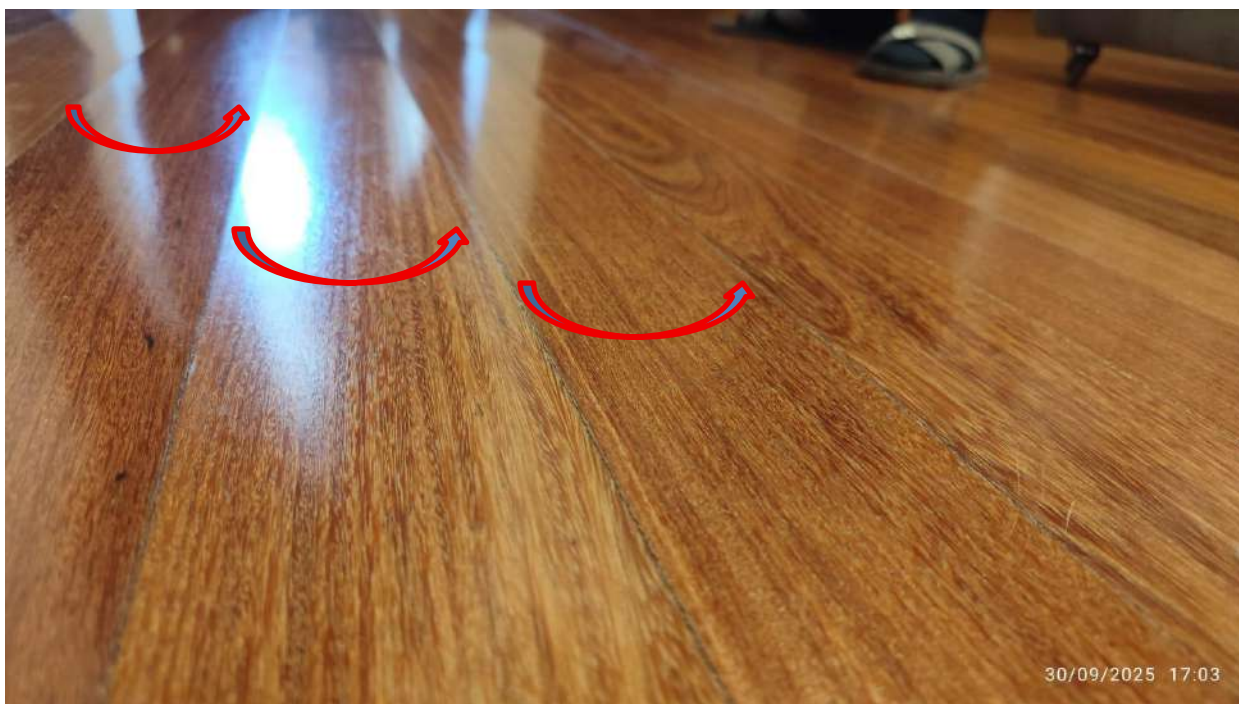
> Detalhe aproximado do taco de madeira. Setas indicam o empenamento do taco.
